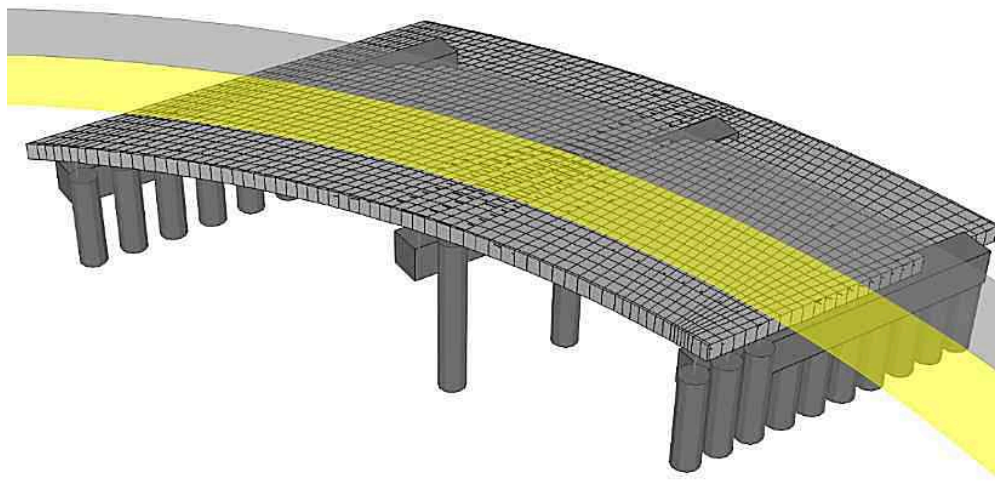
Modélisation 3D du tablier à dalle épaisse en béton précontraint par post-tension avec CSI Bridge
